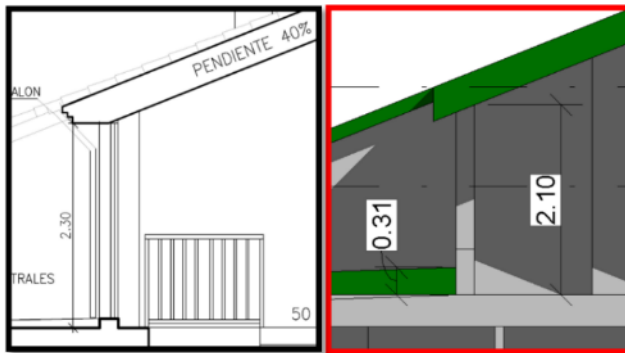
Planta Aprovechamiento bajo cubierta y sección norte-sur por la vivienda A.2014. Elaboración propia.
